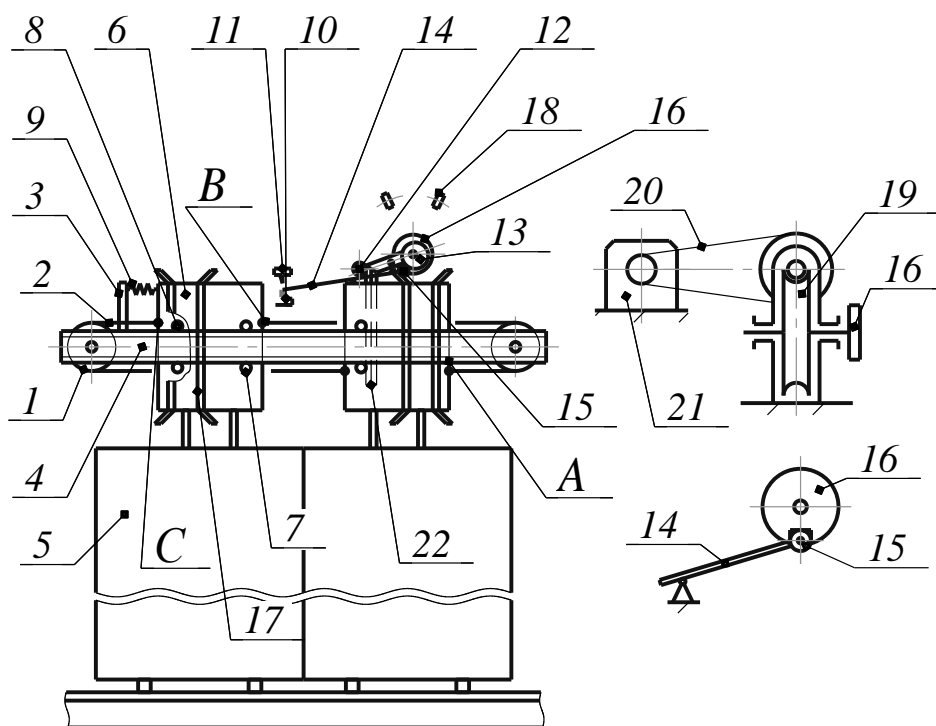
Автоматичні двері кабіни: 1 – блок; 2 – канат; 3 – упор; 4 – балка; 5 – стулка; 6 – каретка; 7 – контролик; 8 – робочий ролик; 9 – пружина; 10 – замок; 11 – контактний пристрій; 12 – ролик; 13 – ексцентрик; 14 – важіль; 15 – ролик; 16 – шайба; 17 – важіль; 18 – контактний пристрій; 19 – редуктор черв'ячний; 20 – клинопасова передача; 21 – електродвигун
